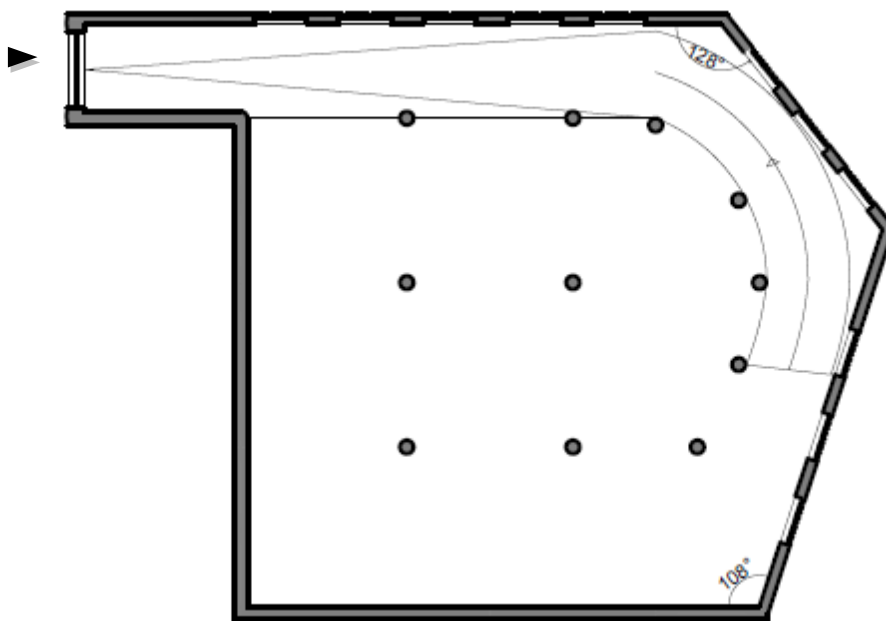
Planta Piso -1 Existente, Escala 1/500 (Autora, 2019)
